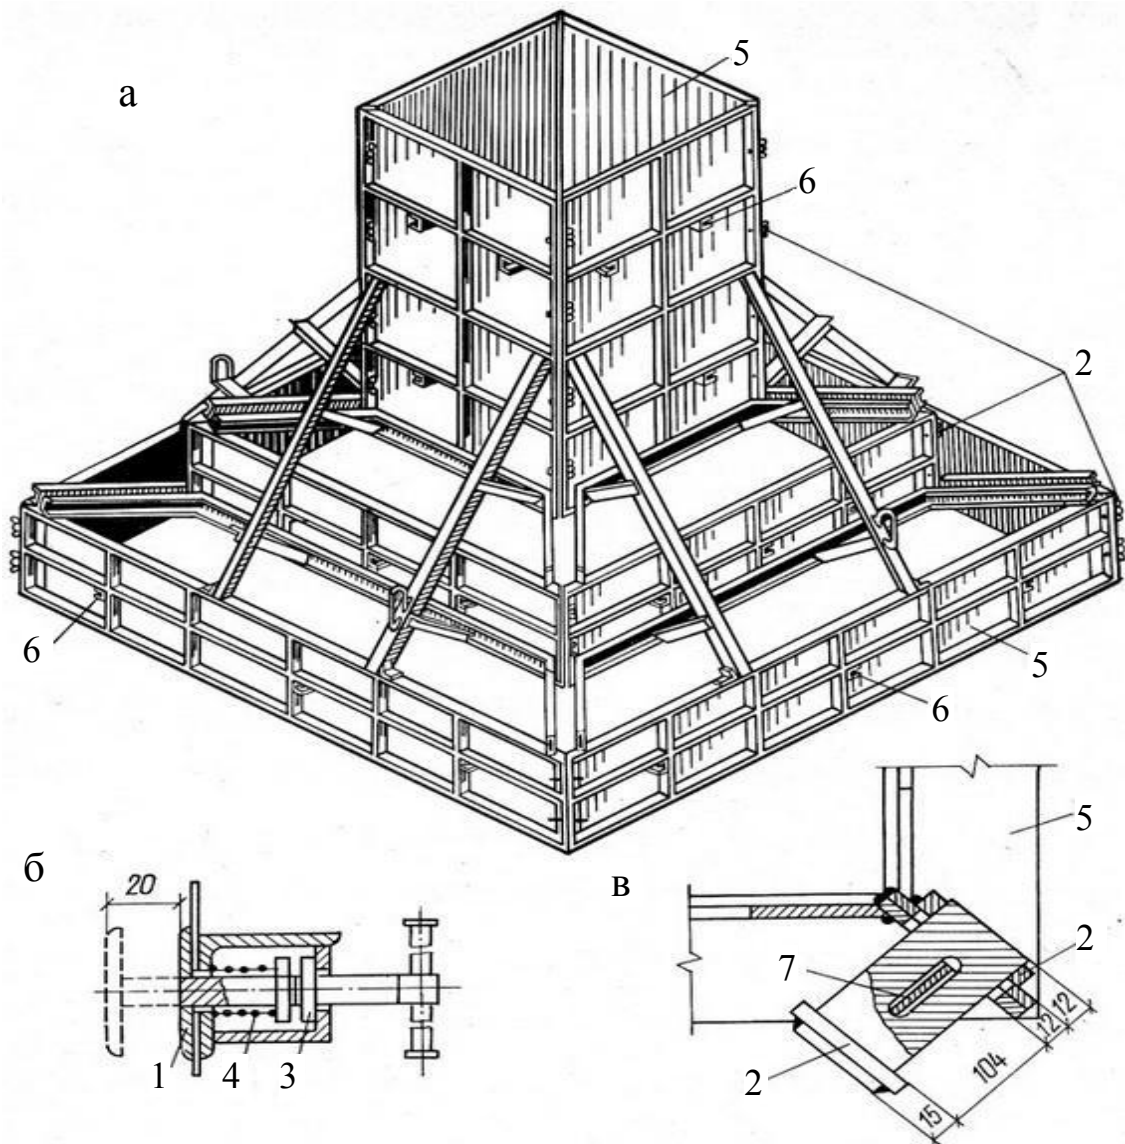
Рознімна блок-форма: а – загальний вигляд; б – відтискний пристрій; в – вузол з'єднання стулок; 1 – опорна пластинка; 2 – клиновий замок; 3 – гвинт; 4 – пружина; 5 – стулка; 6 – відтискний пристрій; 7 – клин
